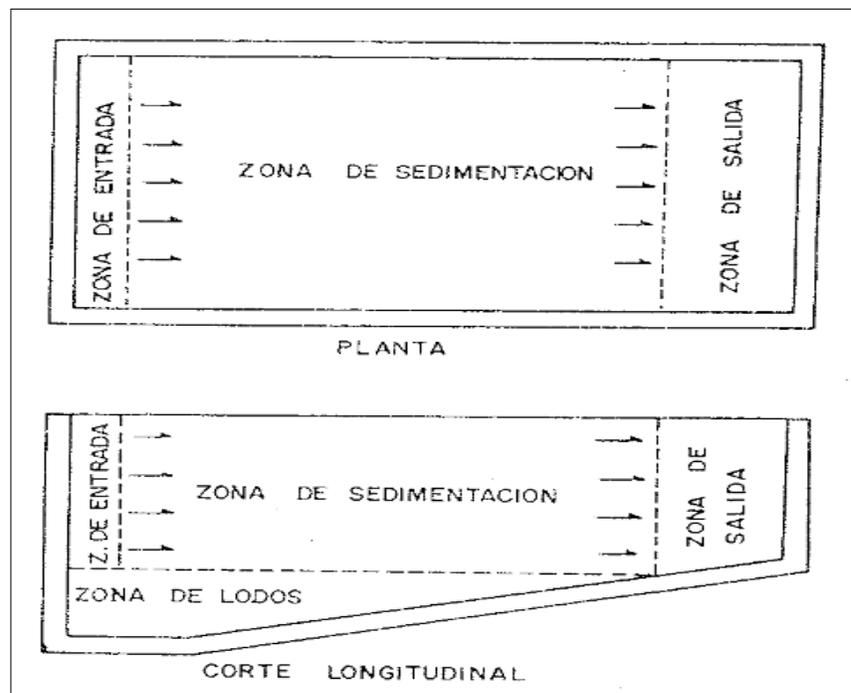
Zona que componen el desarenador (Vista en Planta y en Perfil
